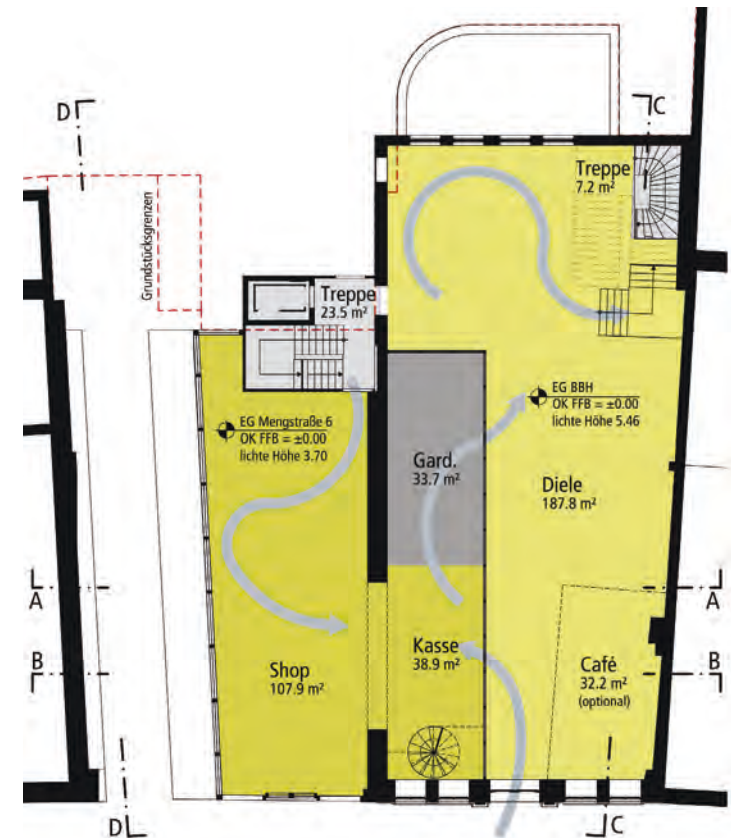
Variante 2, Grundriss Erdgeschoss
